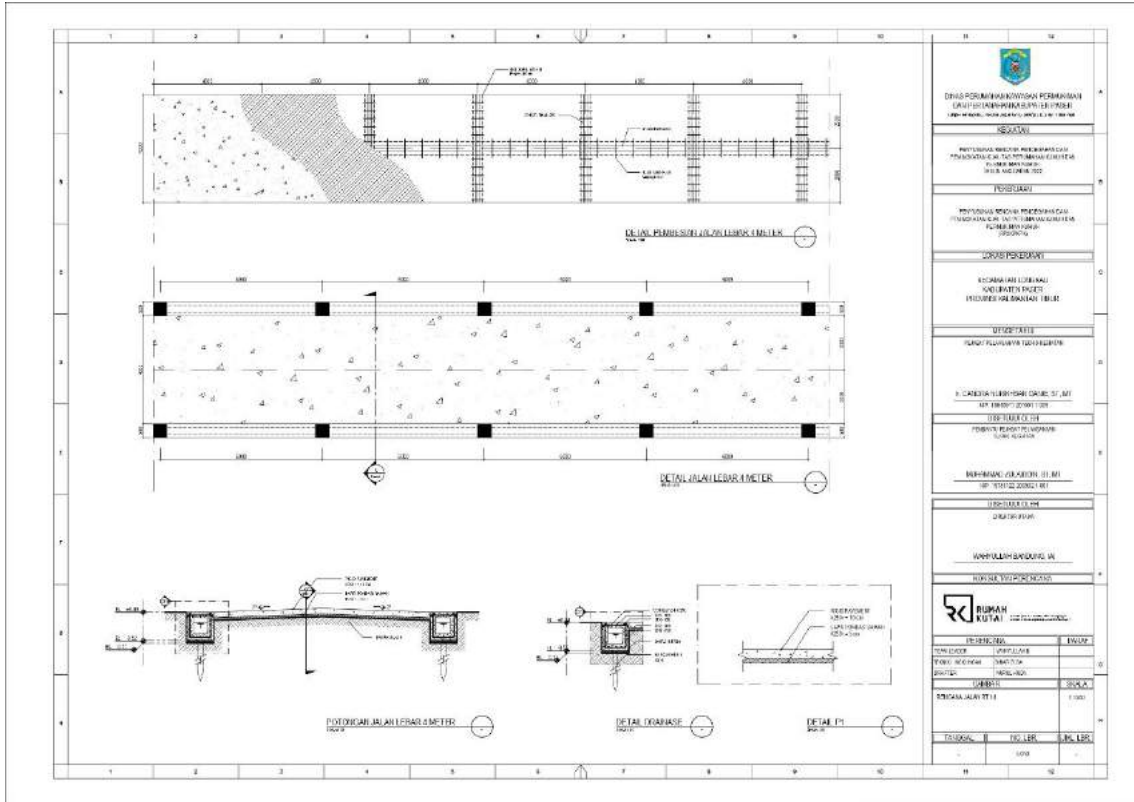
91 Konsep Recana Jalan Segmen 9 RT.14
